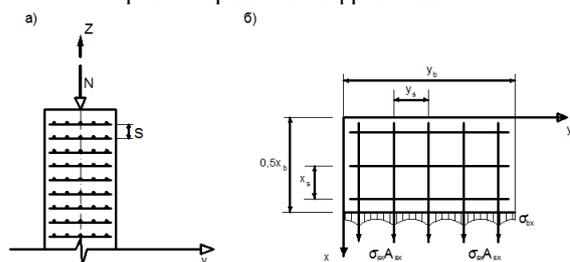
Железобетонный элемент с сетчатым армированием: а – вид сбоку; б – схема усилий в рассматриваемом фрагменте.
